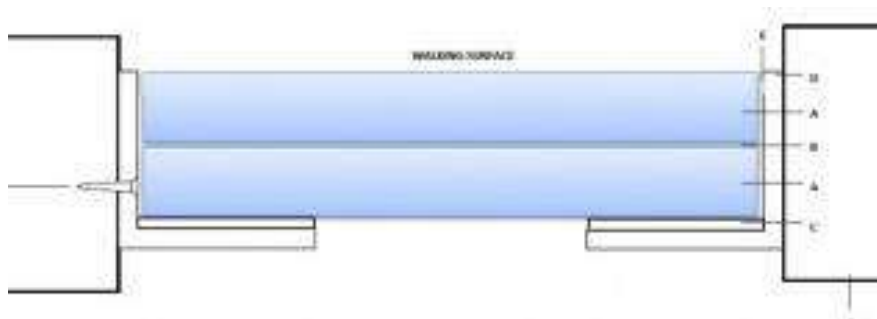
Pormenor construtivo da aplicação de vidro no piso
